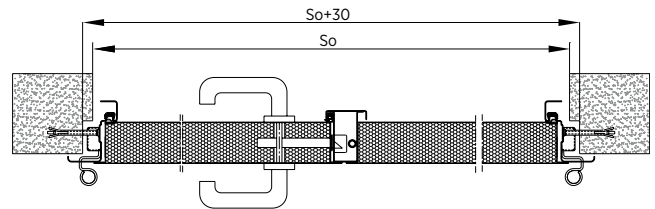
Pose au mur – bloc-porte à deux vantaux, bâti angulaire sans rupture de pont thermique – coupe horizontale
